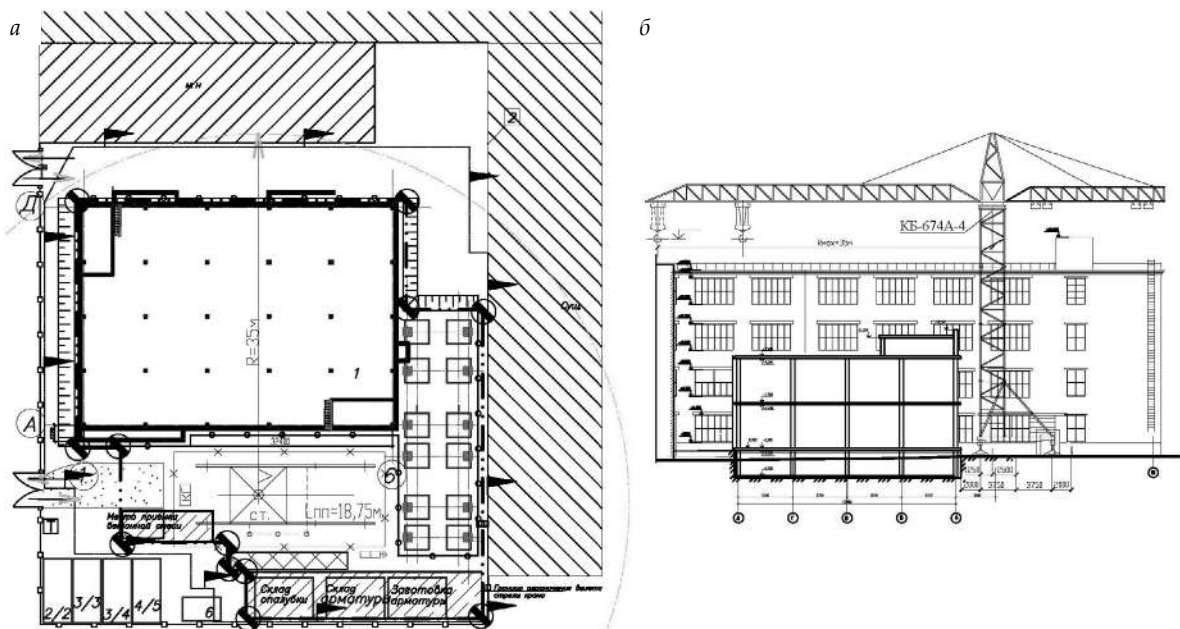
Расчетная схема установки башенного крана при возведении корпуса микрoeлектронных технологий: а – схема-план; б – схема-разрез
